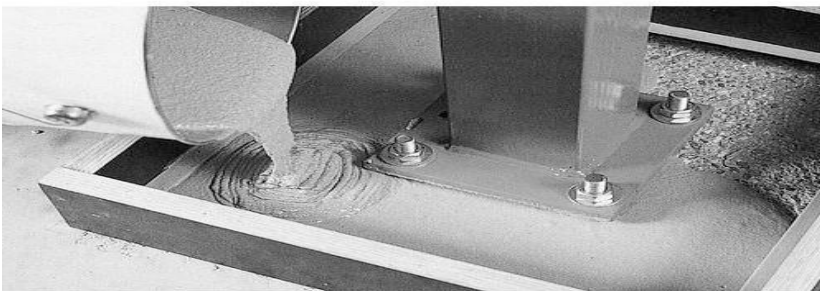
Encofrado externo típico alrededor de un pie de apoyo
